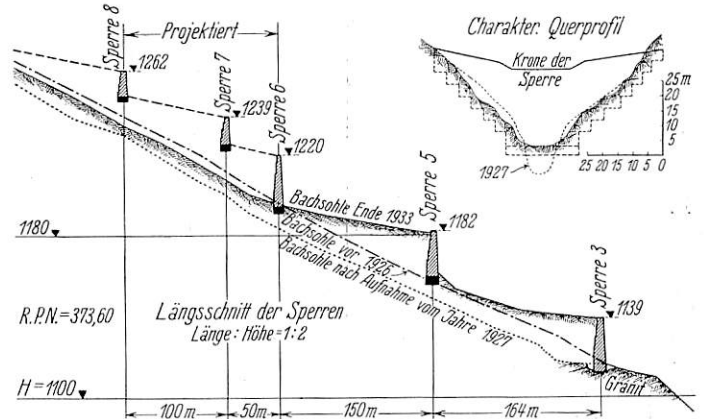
Längenschnitt der Sperrengruppe auf Alp Foillet.
